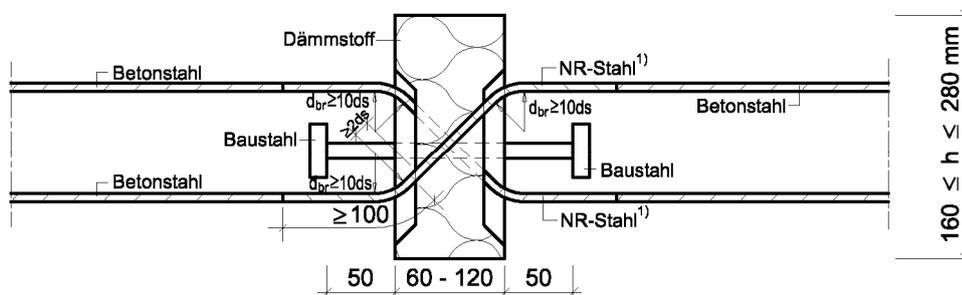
Schöck Isokorb Typ Q+Q ¹⁾
